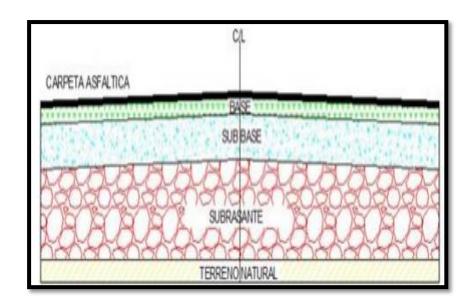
Estructura de un pavimento flexible. (Mora y Mendoza, 2016)
